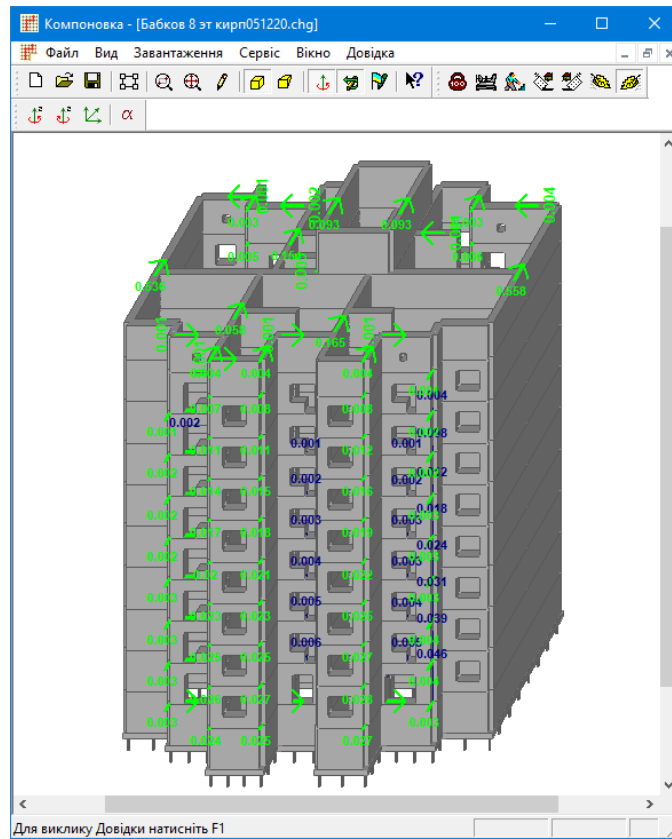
Вітрове навантаження (вітер 2– на головний фасад).
